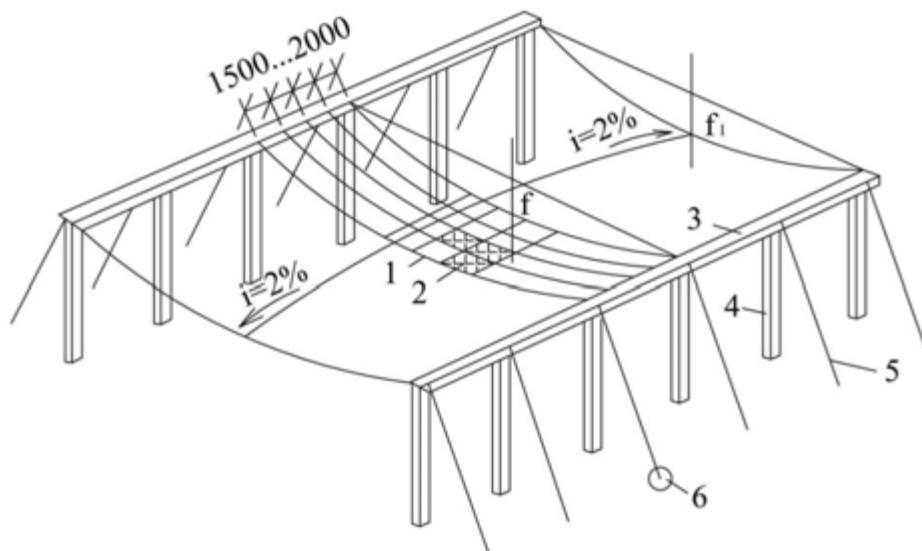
Висяче покриття будівлі із прямокутними поясами:
